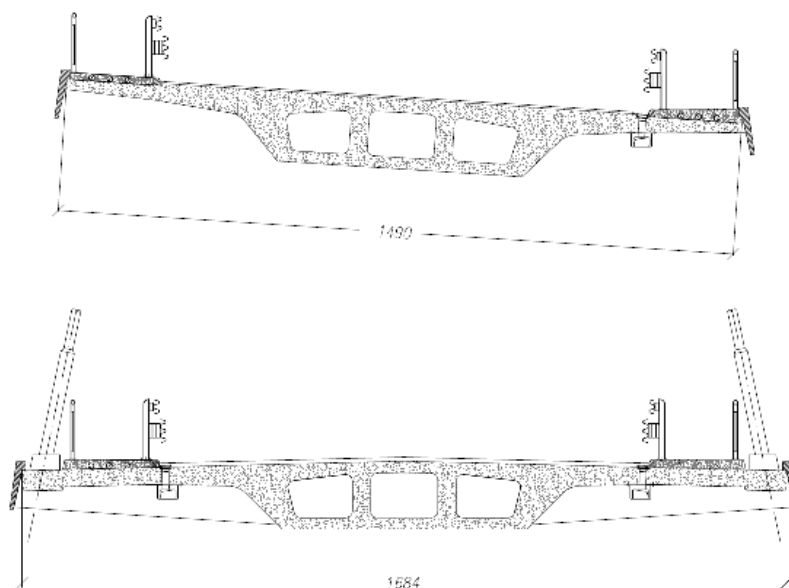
Sezioni trasversali dell'impalcato: in alto la sezione tipica dei viadotti, in basso la sezione dell'impalcato strallato
